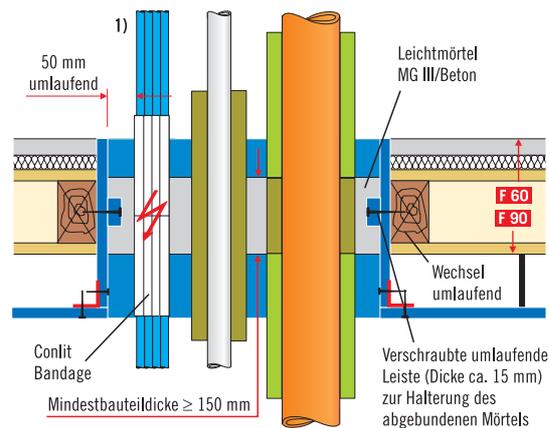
Beispiel zur Abschottung einer Holzbalkendecke mit F 90-Unterdecke und integriertem Leichtmörtel MG III/Beton innerhalb einer F 90-Auslaibung
